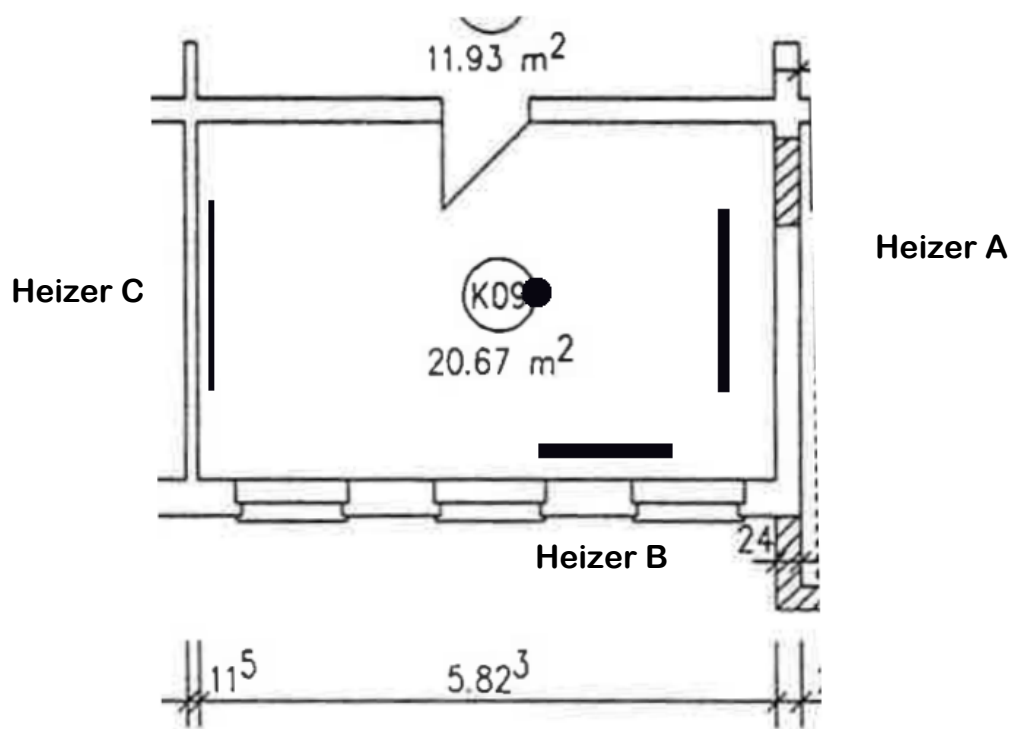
Grundriss des Versuchsraums, Höhe 249 cm
